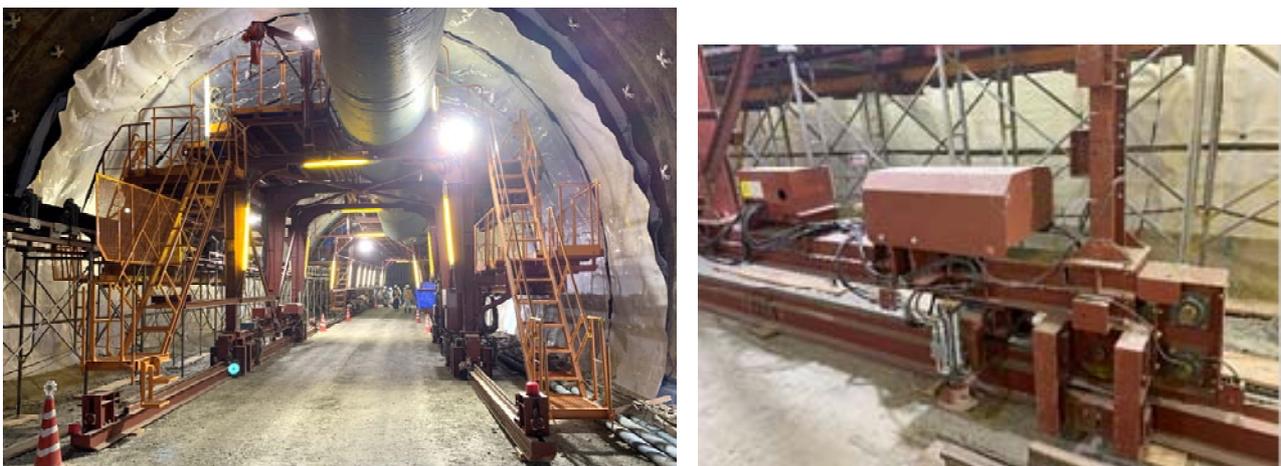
Rail Walker System の現場適用『福島県博士トンネル工事(昭和村側工区)』
